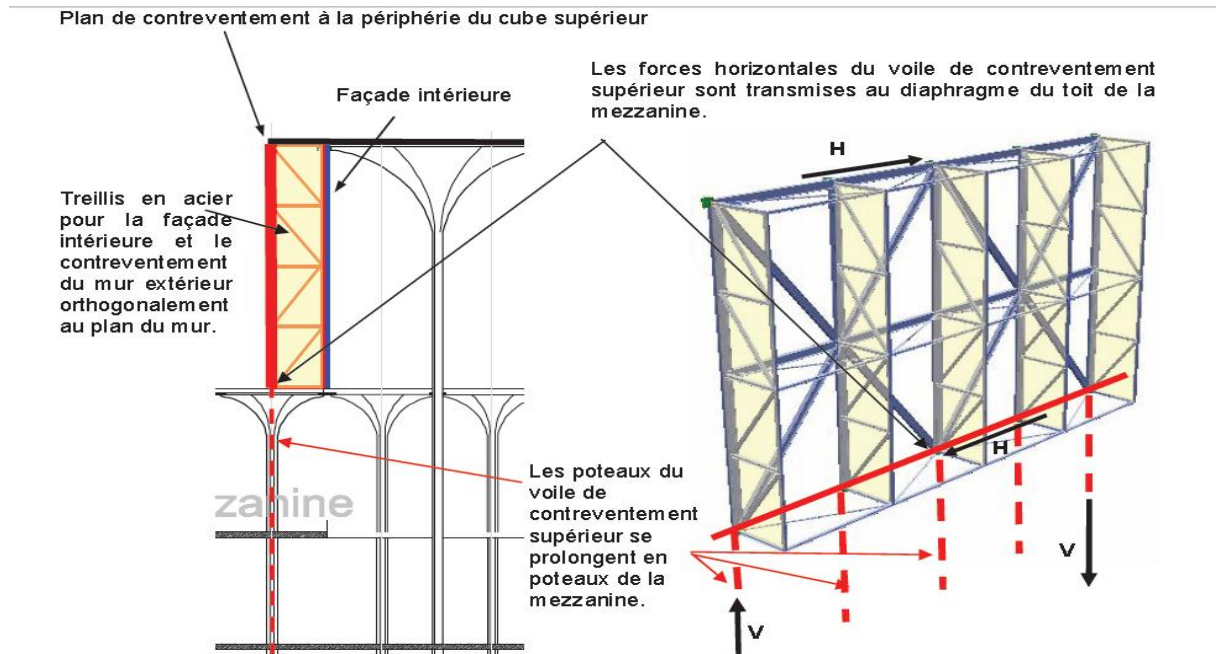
Plan de contreventement du cube supérieur à 22 m et à 45 m (à gauche : coupe transversale ; à droite mur formé par un treillis spatial léger)
